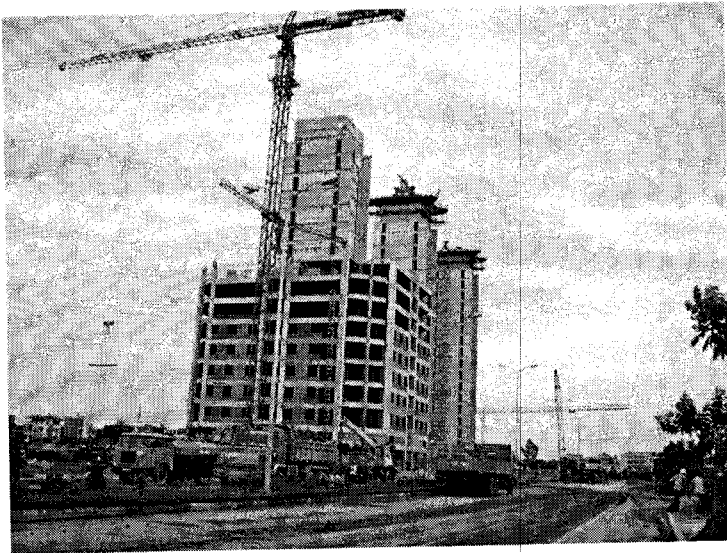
Kết cấu lắp ghép bằng cấu kiện bê tông ứng suất trước tại công trình Mê Linh Plaza (Vĩnh Phúc)
